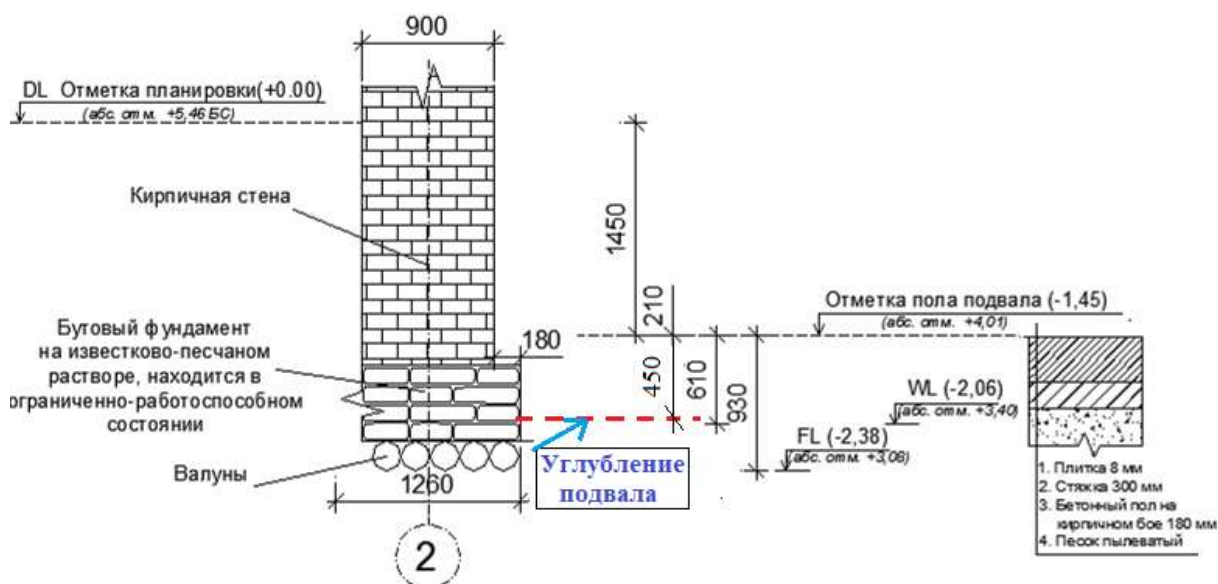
Поперечный разрез существующего ленточного бутового фундамента реконструируемого здания по оси 2
